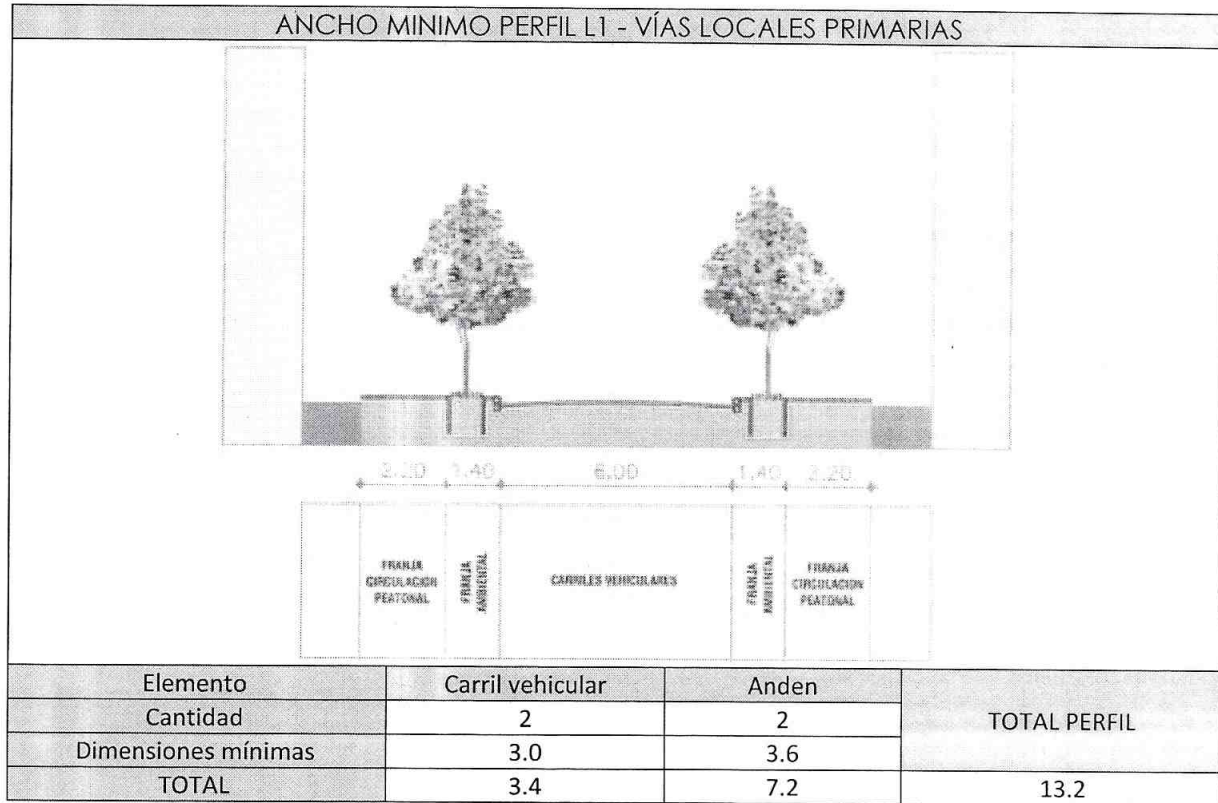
Ancho mínimo perfil I1 - vías locales primarias
